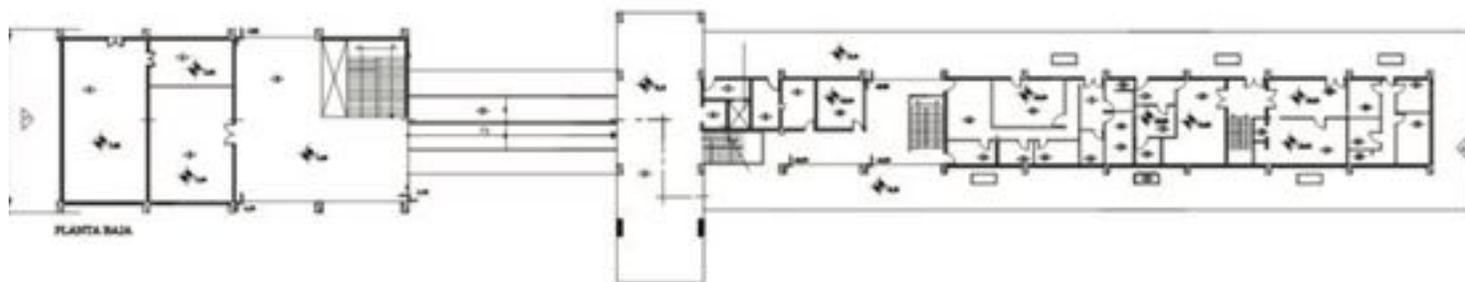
Plano de la planta baja original. Fuente: José Manuel Izquierdo, 2013.
